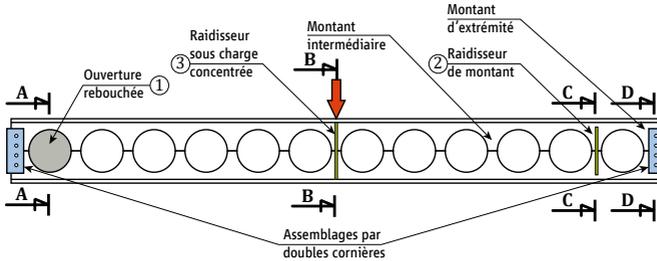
Principales dispositions constructives pour une poutre cellulaire
